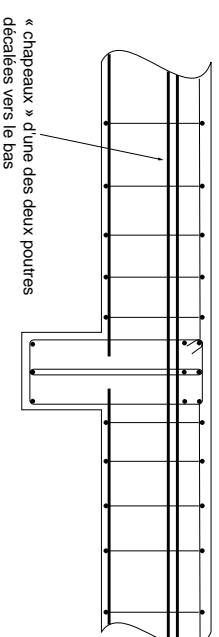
appui d'une poutre sur une autre poutre, incidence sur la position des armatures.
